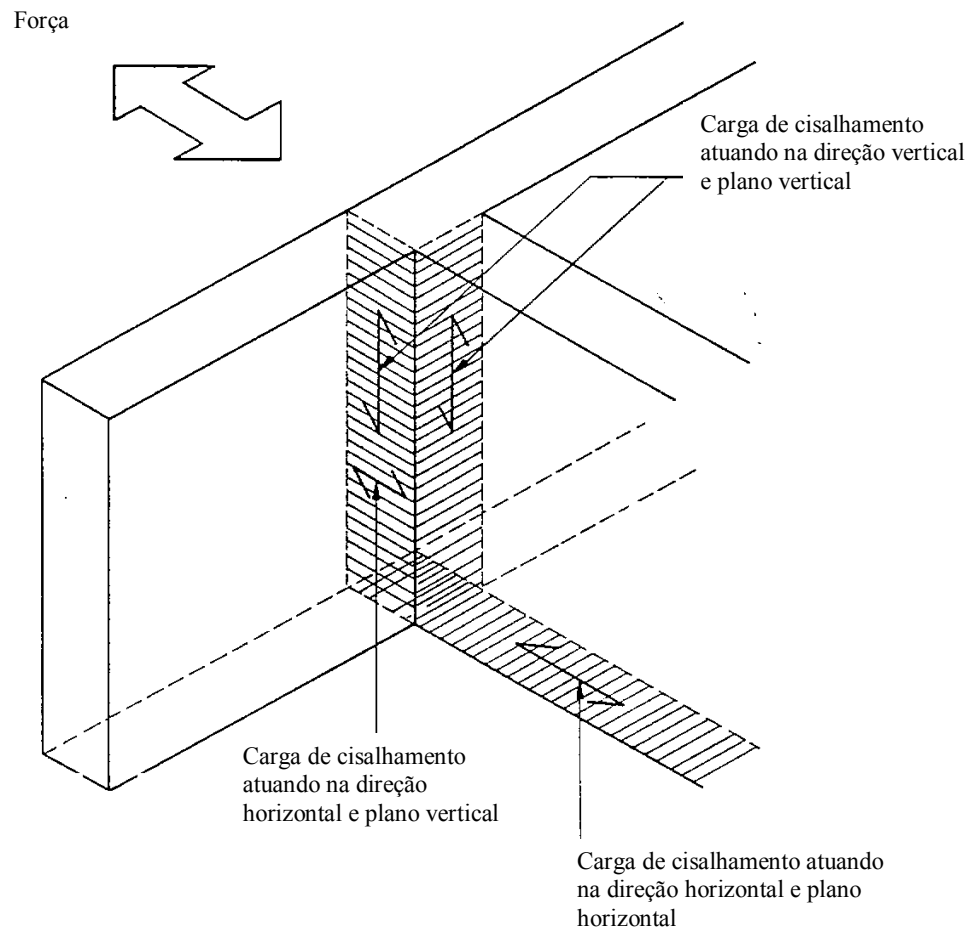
Plano e direção de aplicação das cargas de cisalhamento (BS 5628).
